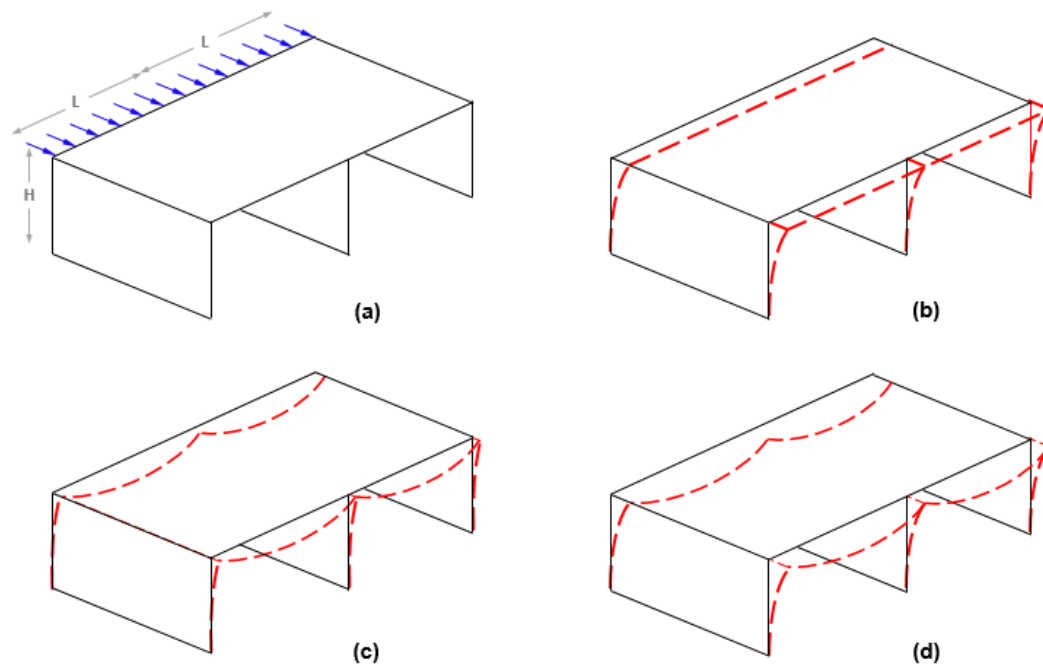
(a) Sistema estructural sometido a un estado de carga. Tipos de comportamiento de un diafragma: (b) rígido, (c) flexible, y (d) semi-rígido (Adaptado y modificado de Naeim y Boppana, 2001)
